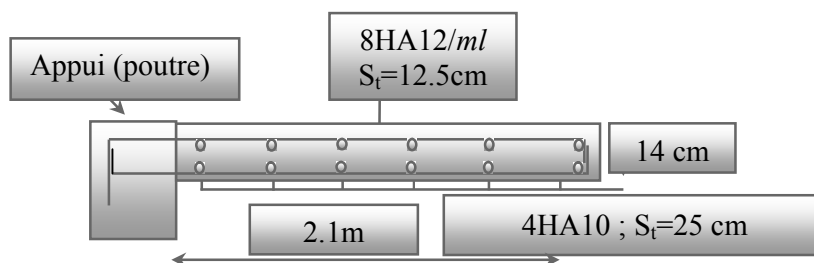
Schéma de ferrailage de la dalle D1(RDC1)
